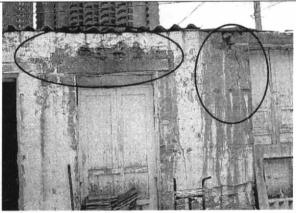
El muro de fachada, visto por el interior del inmueble esta deteriorado y agrietado.
